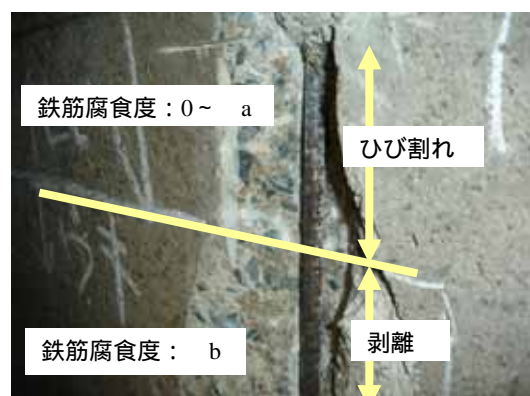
ひび割れ及び剥離箇所での鉄筋はつり出し
